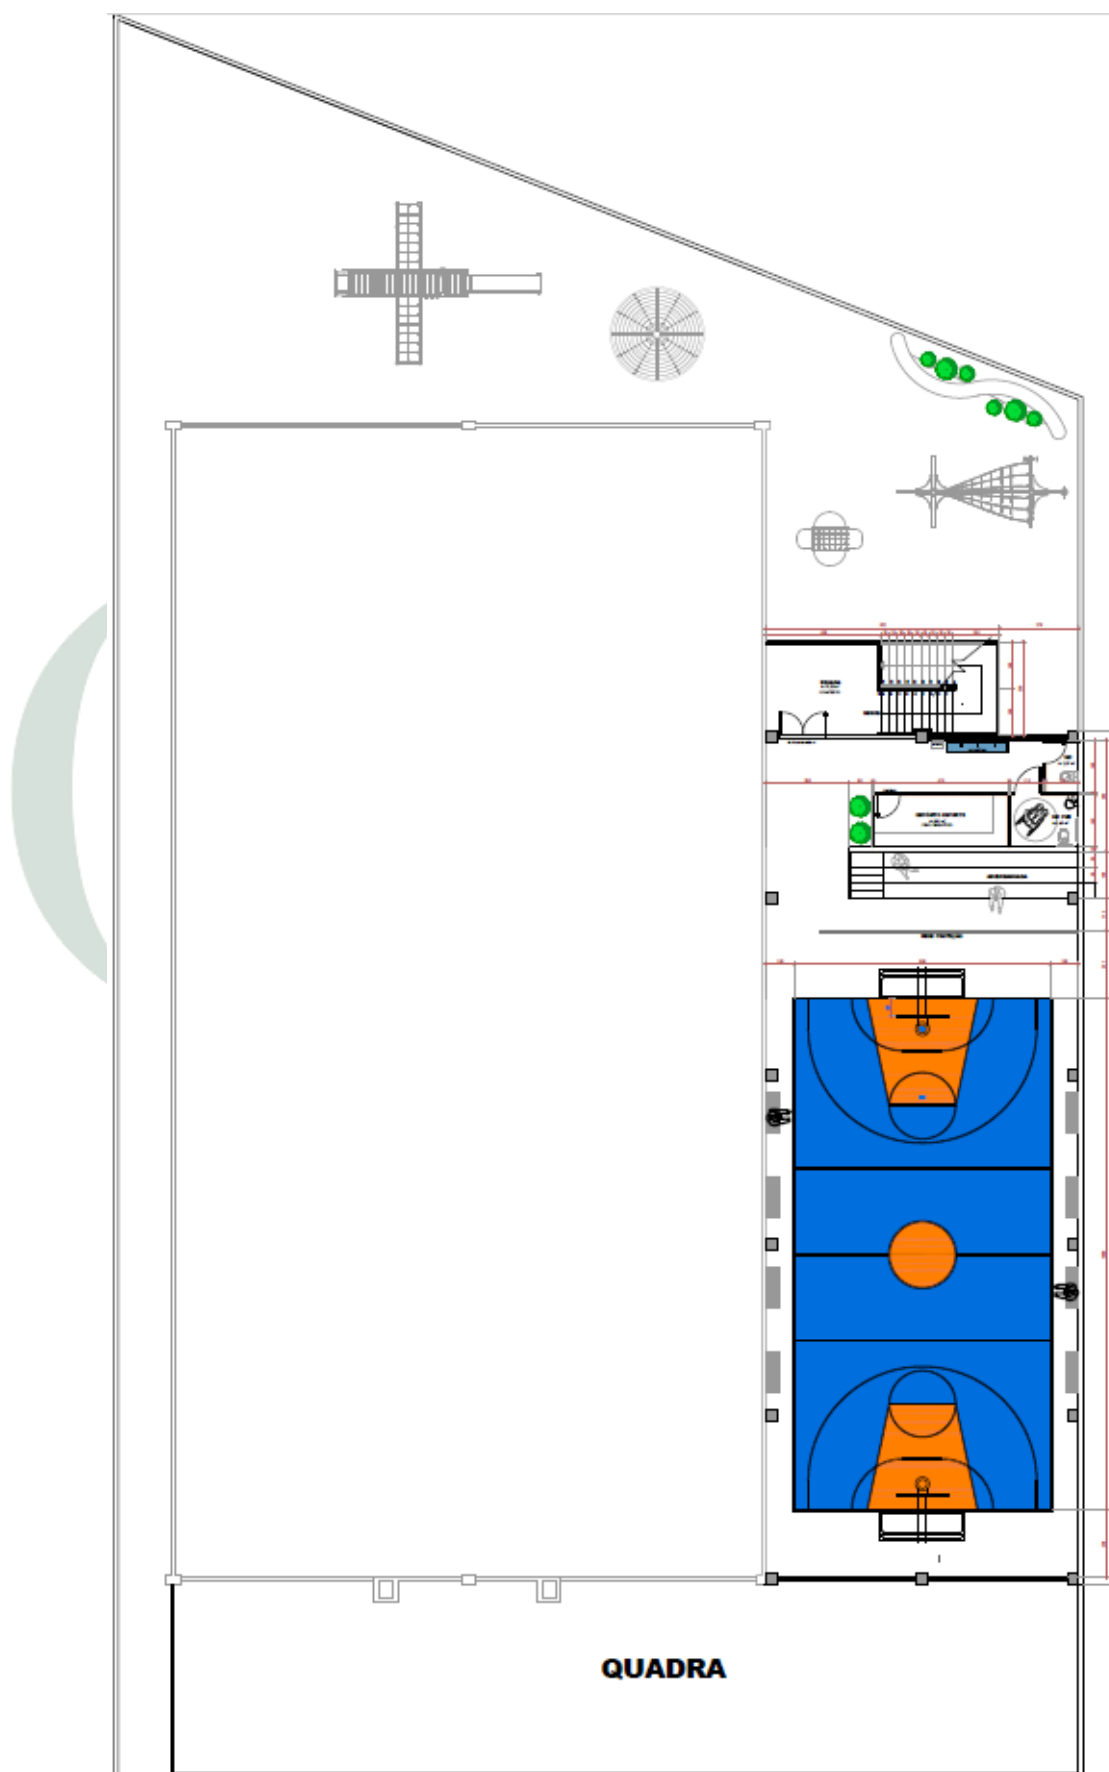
Vista da área da quadra poliesportiva no 3º Pavimento.
